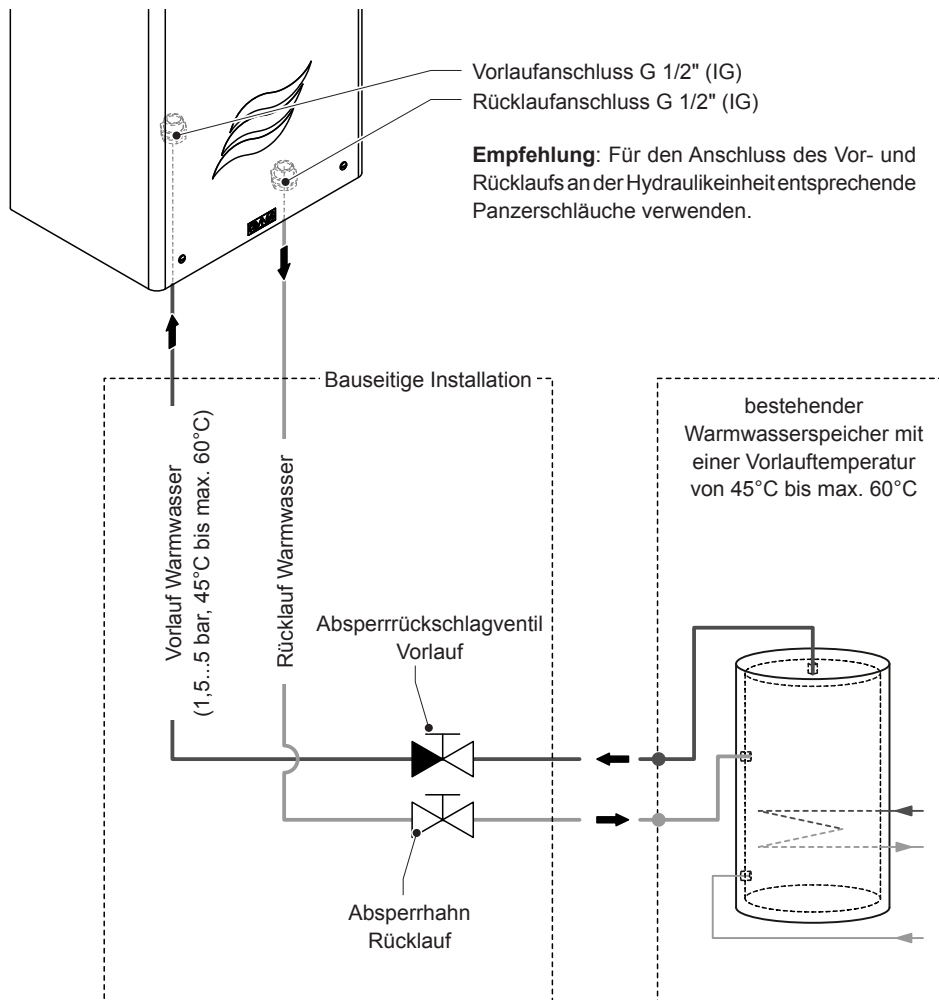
Installationsübersicht Warmwasseranschluss für Variante MD-WW-H
